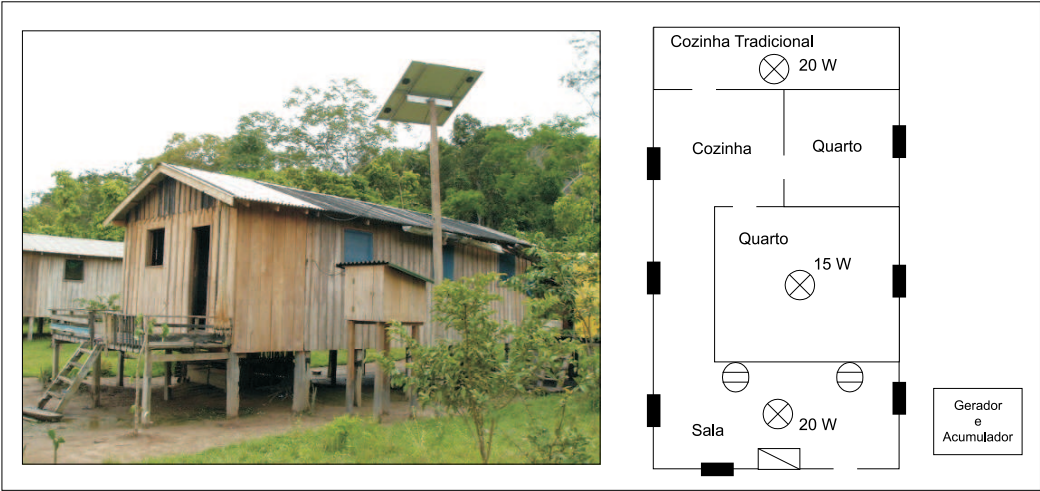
Vista externa do SFD1 e planta aproximada do domicílio.
